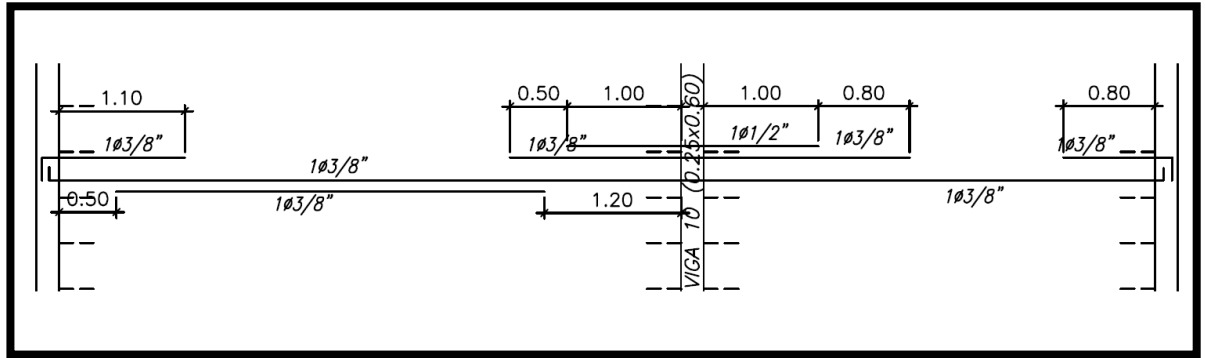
6 Vista en planta del refuerzo del aligerado para los pisos 2, 4 y 6
